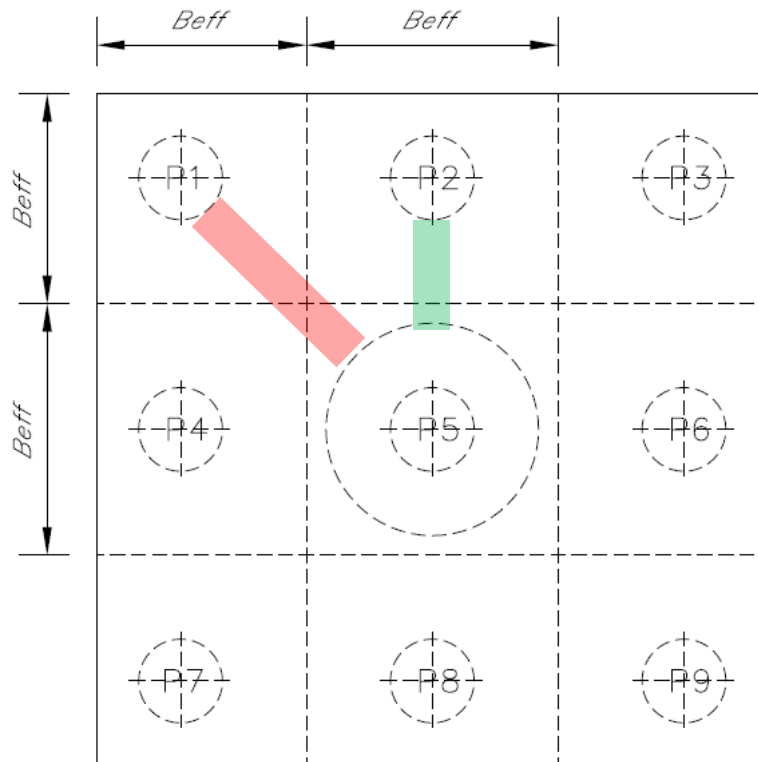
Vista in pianta - Tirante-puntone centrale (verde) e di spigolo (rosso)
